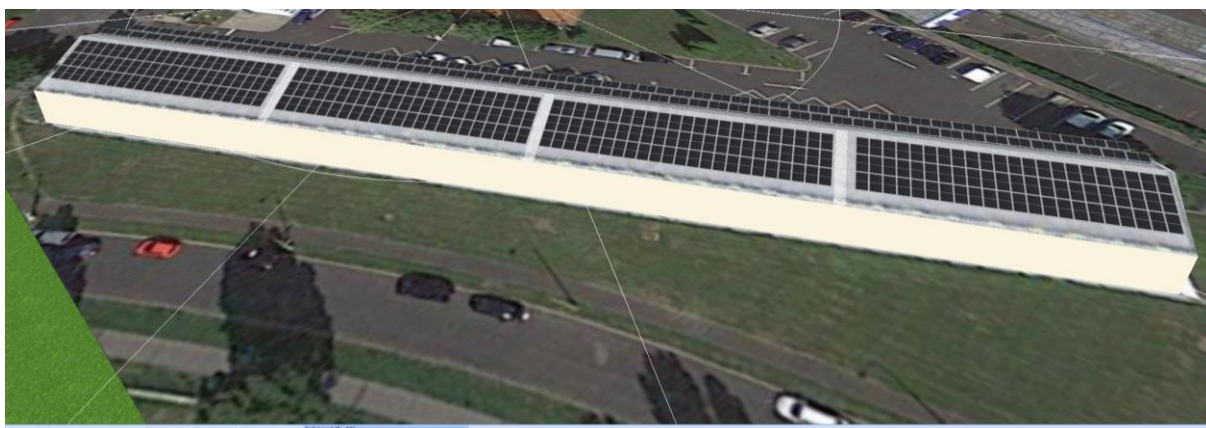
Půdorysy budov s rozmístěním jednotlivých PV modulů
